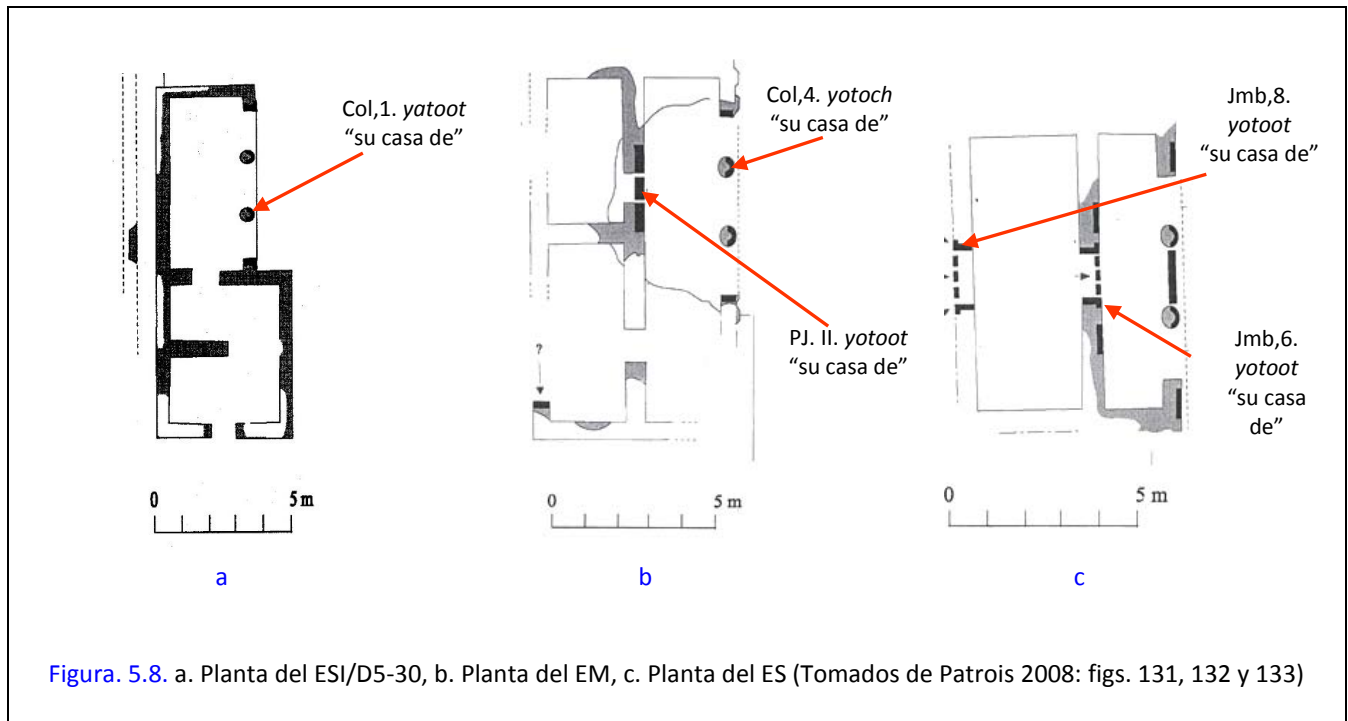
a. Planta del ESI/D5-30, b. Planta del EM, c. Planta del ES (Tomados de Patrois 2008: figs. 131, 132 y 133)
